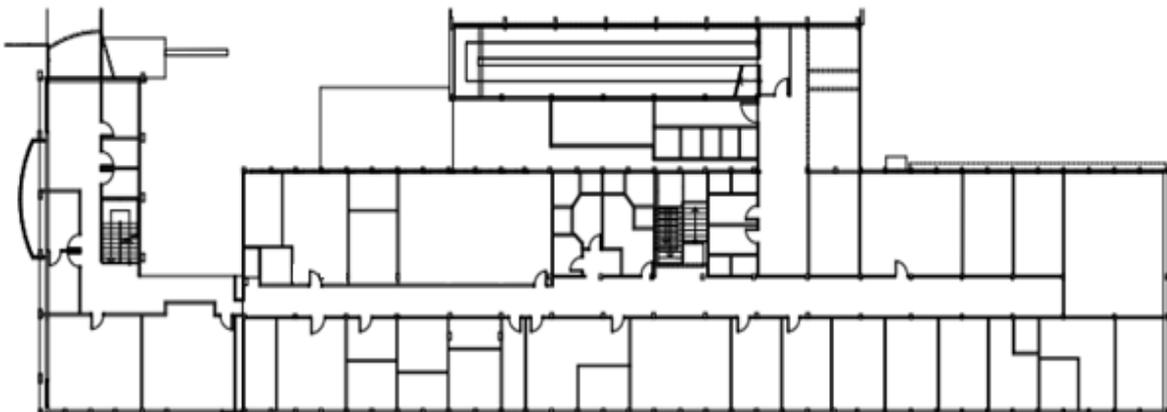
Planta baixa do terceiro pavimento da sede do HEMOSC [1]
